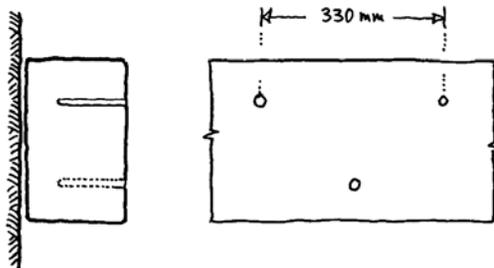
Tratamiento por inyección en longitud en las piezas en contacto con los muros.
